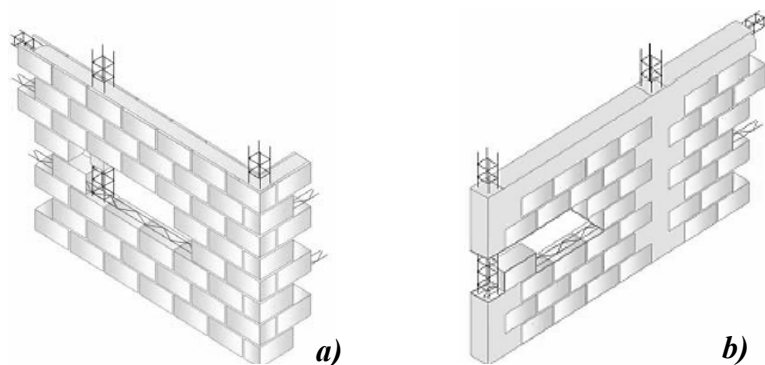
Esquemas representativos de sistemas de alvenaria estrutural mista; a) Alvenaria confinada (montantes e cintas) com armaduras horizontal treliçadas nas juntas de argamassa [7]; b) Alvenaria confinada (pilares e vigas) com armaduras horizontal treliçadas nas juntas de argamassa [7].
